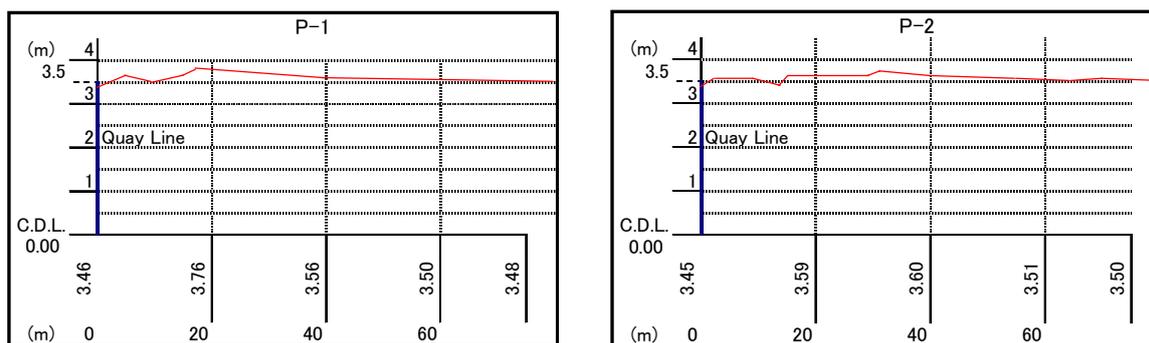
Secções P-1 e P-2 do Cais Norte
